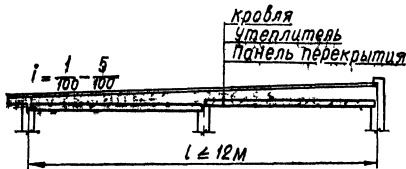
Совмещенная крыша с наклонной кровлей в сторону дворового фасада
